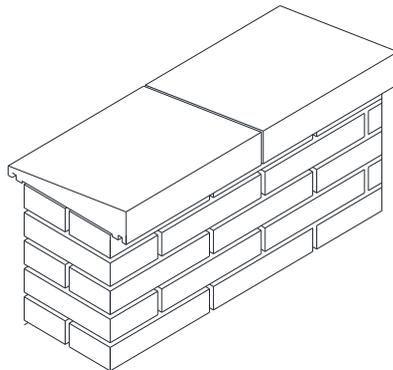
Detalle constructivo de albardilla. Fuente propia 2014.
